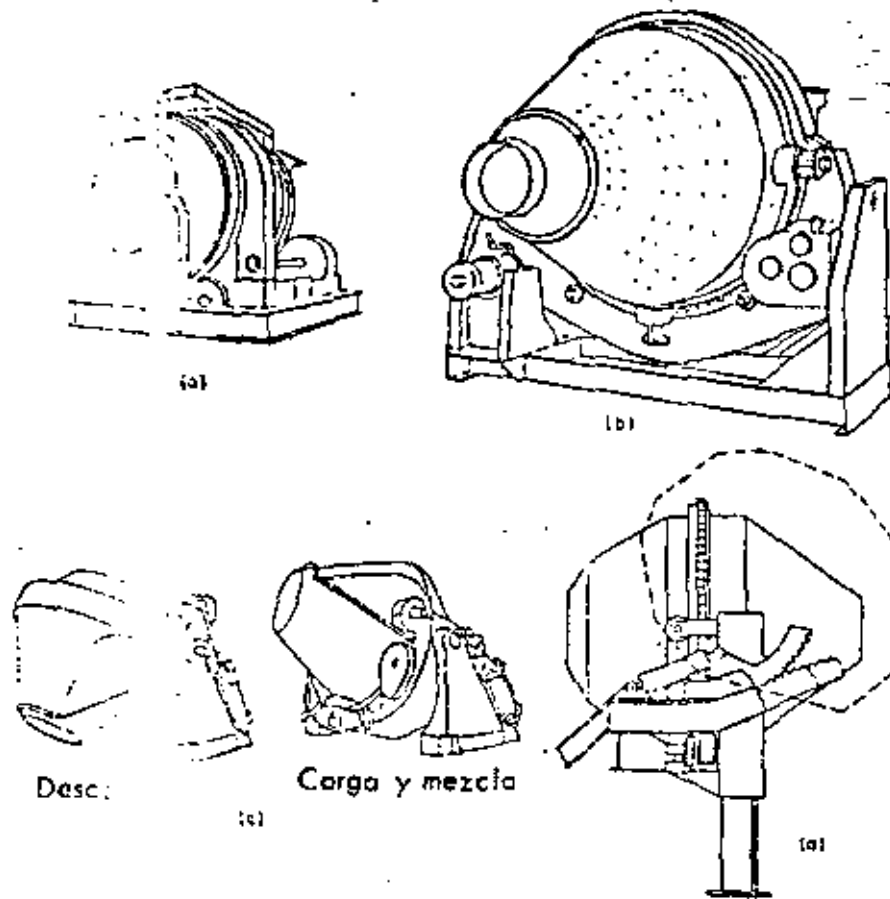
Plantas Revolvedoras de concreto de mezclado por caída libre.
